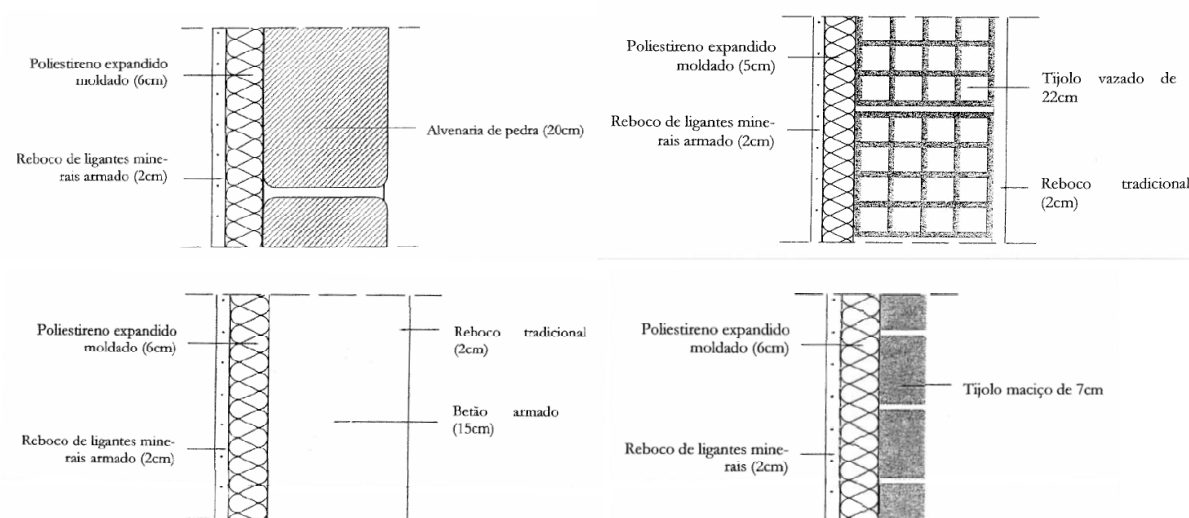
4 soluções construtivas de parede simples com isolamento contínuo pelo exterior [14]
